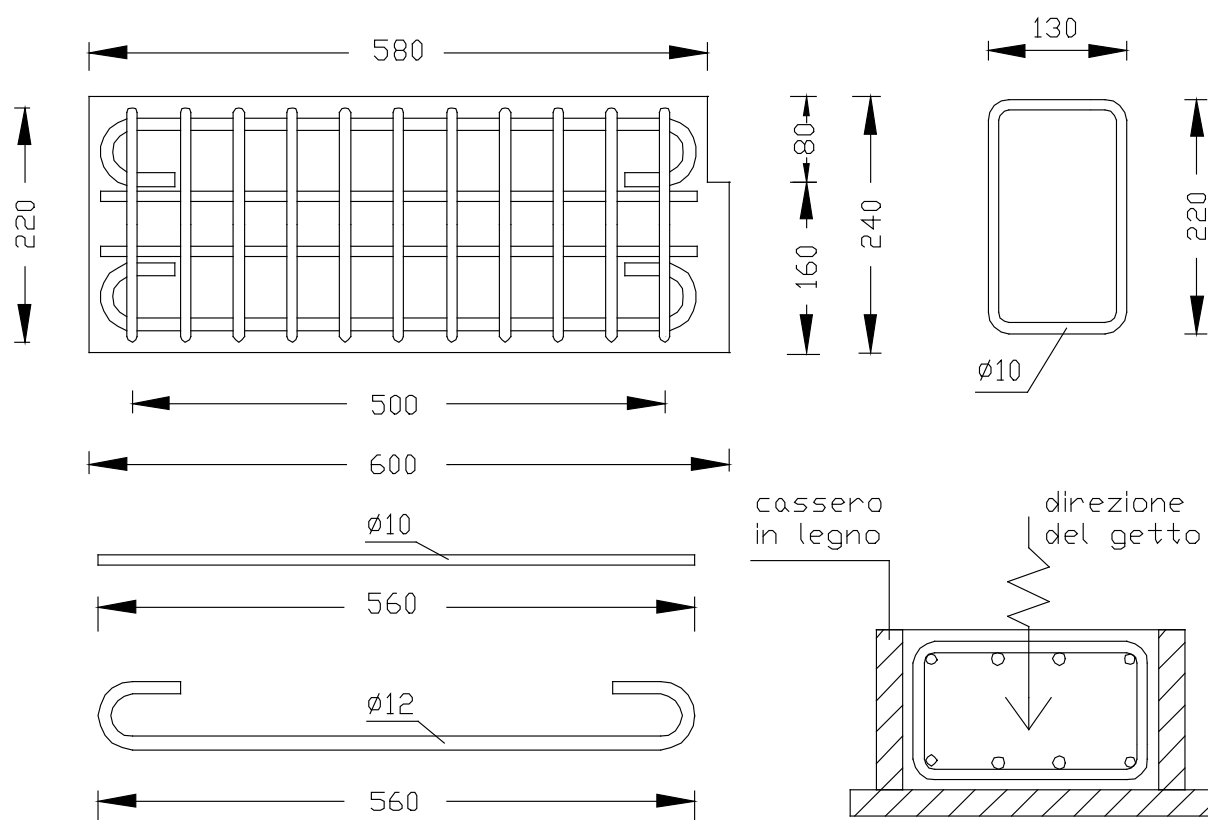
Particolare dell'armatura contenuta nel provino di trave.
